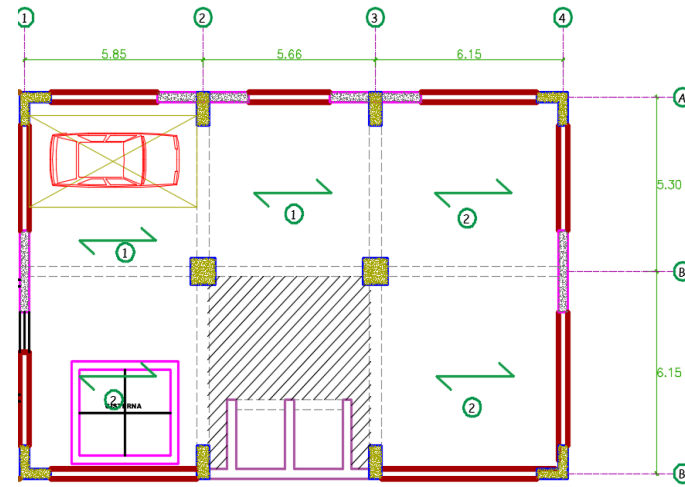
Plano estructural del 1º piso de la alternativa 01.
